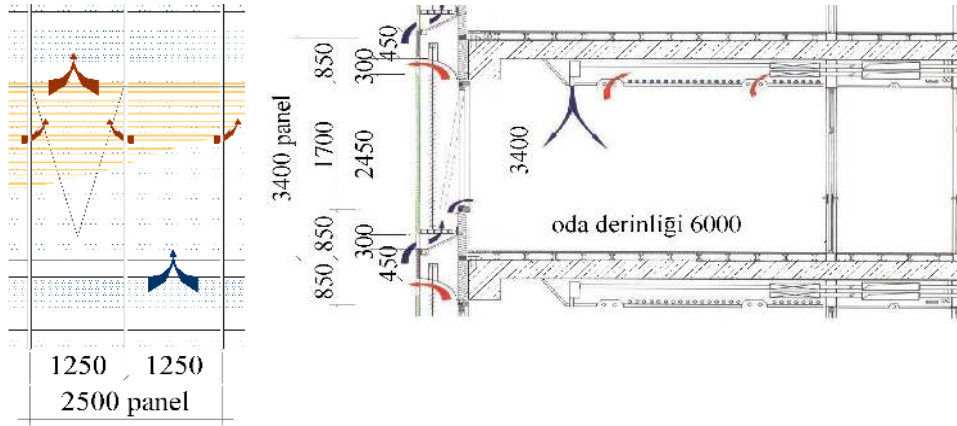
Analizde kullanılacak olan ofis binasının şematik planı
